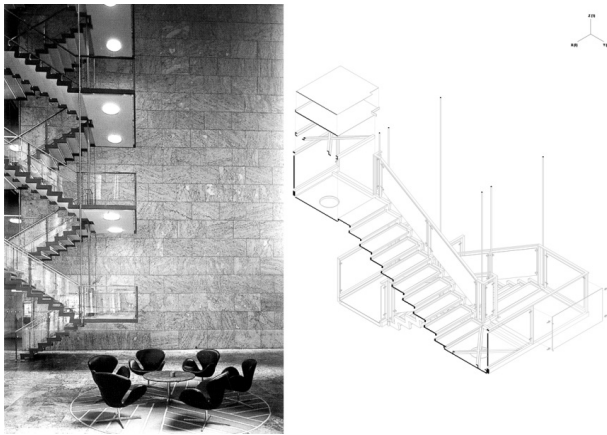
Detalle constructivo en axonométrico y fotografía lateral de la escalera. 1981. Space Design, pp.44.
